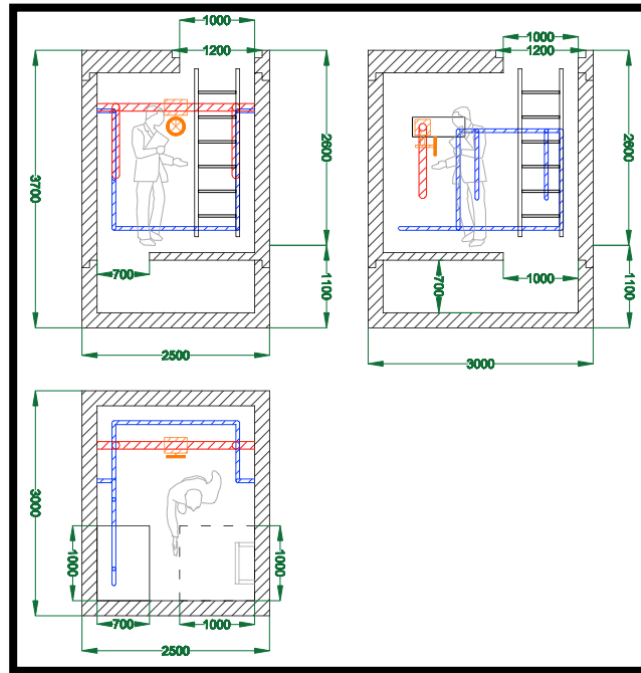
Sezione di Camera Tipo "Sectionnement"
